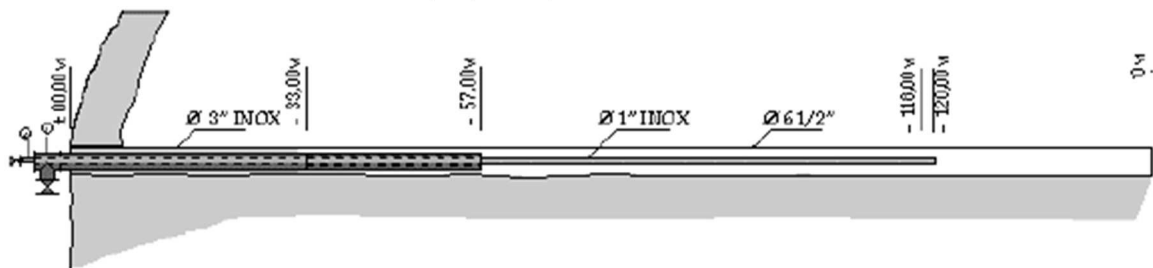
Cabeça da captação dupla - Furo Horizontal
